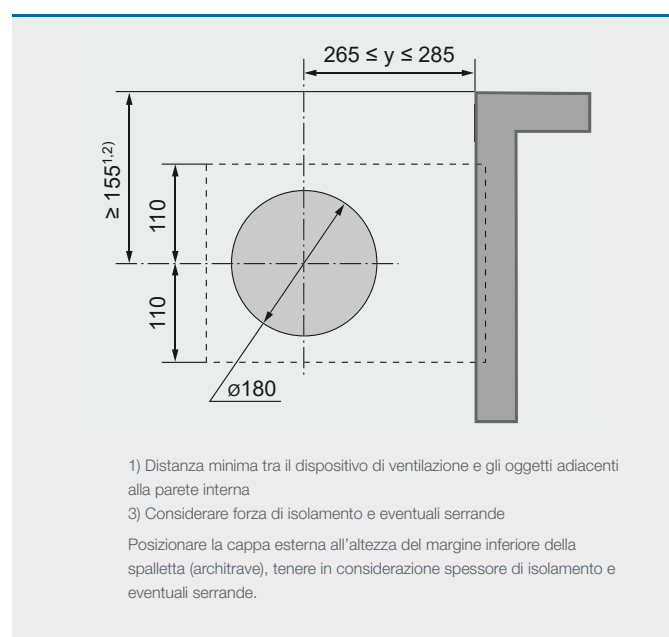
Schema dell'apertura nella parete, canale piatto 400 mm
